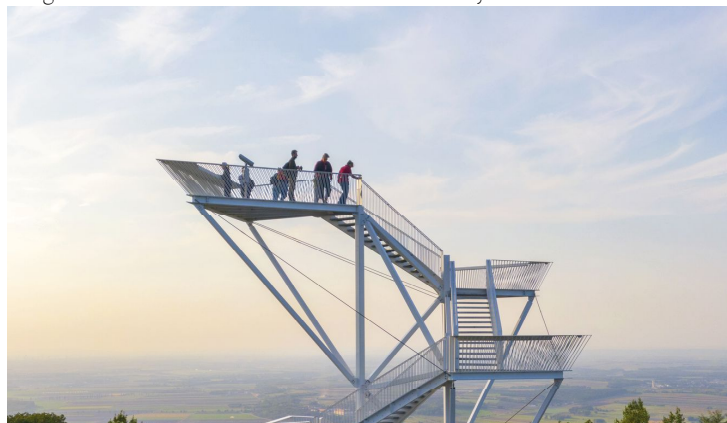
Alzado de la estructura y juego espacial de vigas y barandilla.
